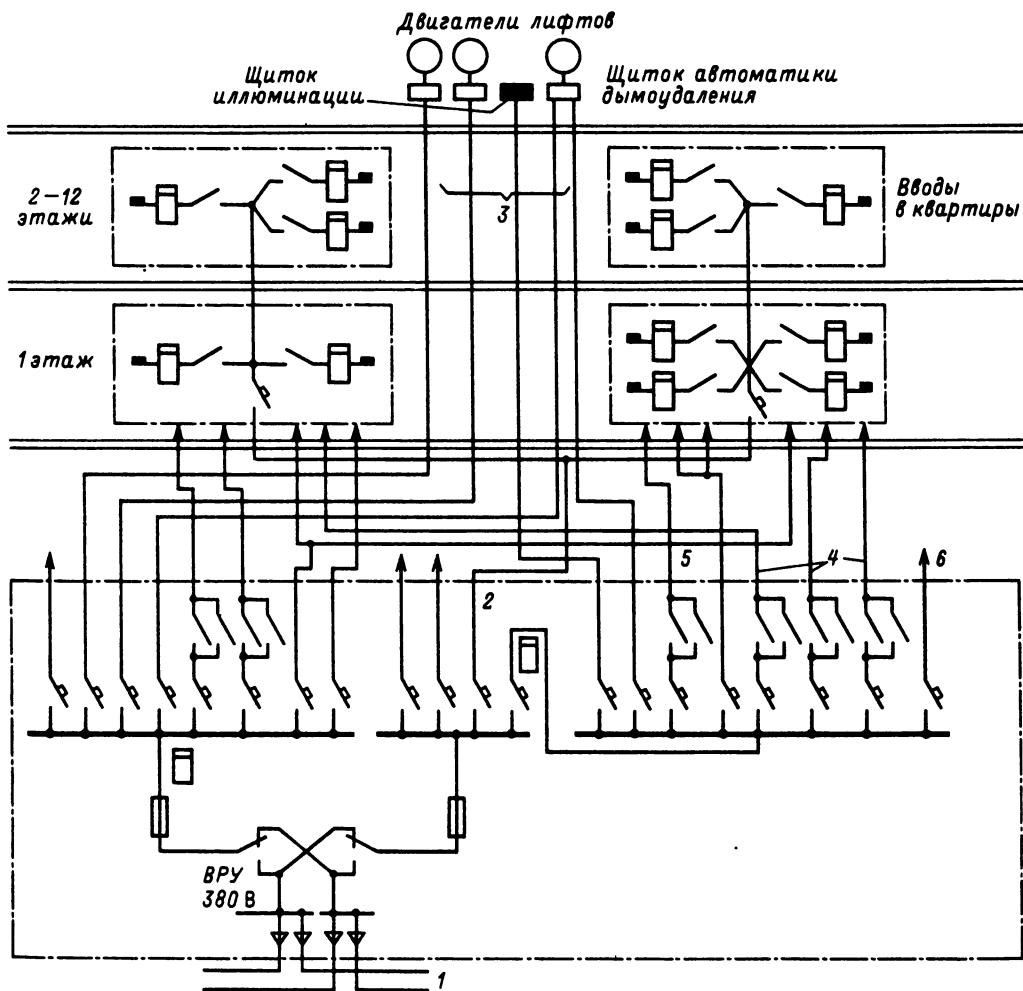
Упрощенная принципиальная схема ВРУ и схемы внутренней сети 380 В 12-этажного жилого дома:
